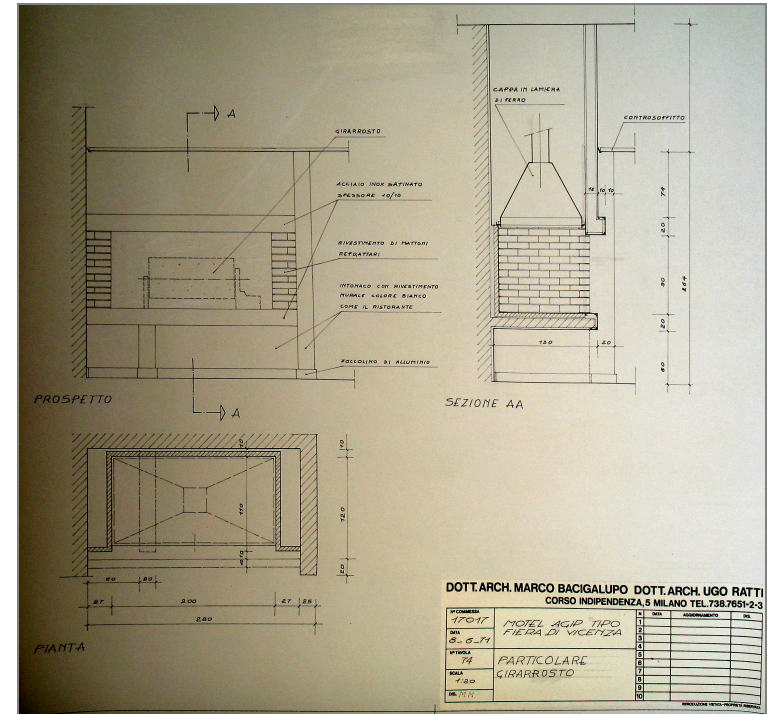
particolare girarosto (fonte CSAC – stralcio tav. 74, archivio n. 161-1)
